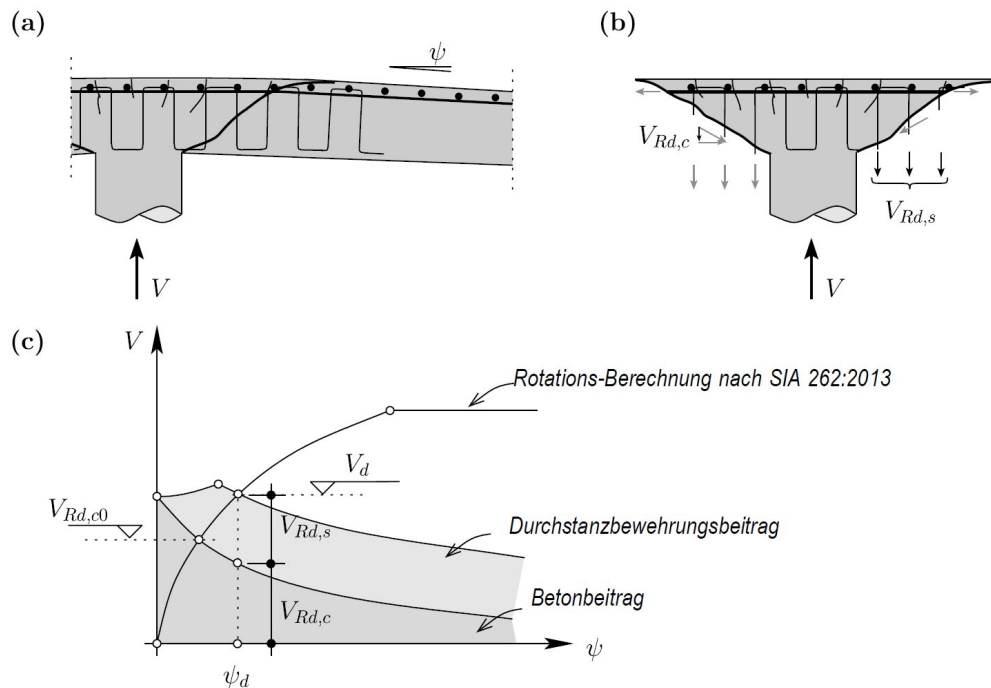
Beiträge des Betons und der Durchstanzbewehrung zur Aufnahme der Querkraft: (a) Aktivierung der Bewehrungen; (b) Beton- und Bewehrungsbeitrag; und (c) Ermittlung der Beiträge auf der Grundlage der Theorie von dem kritischen Riss
